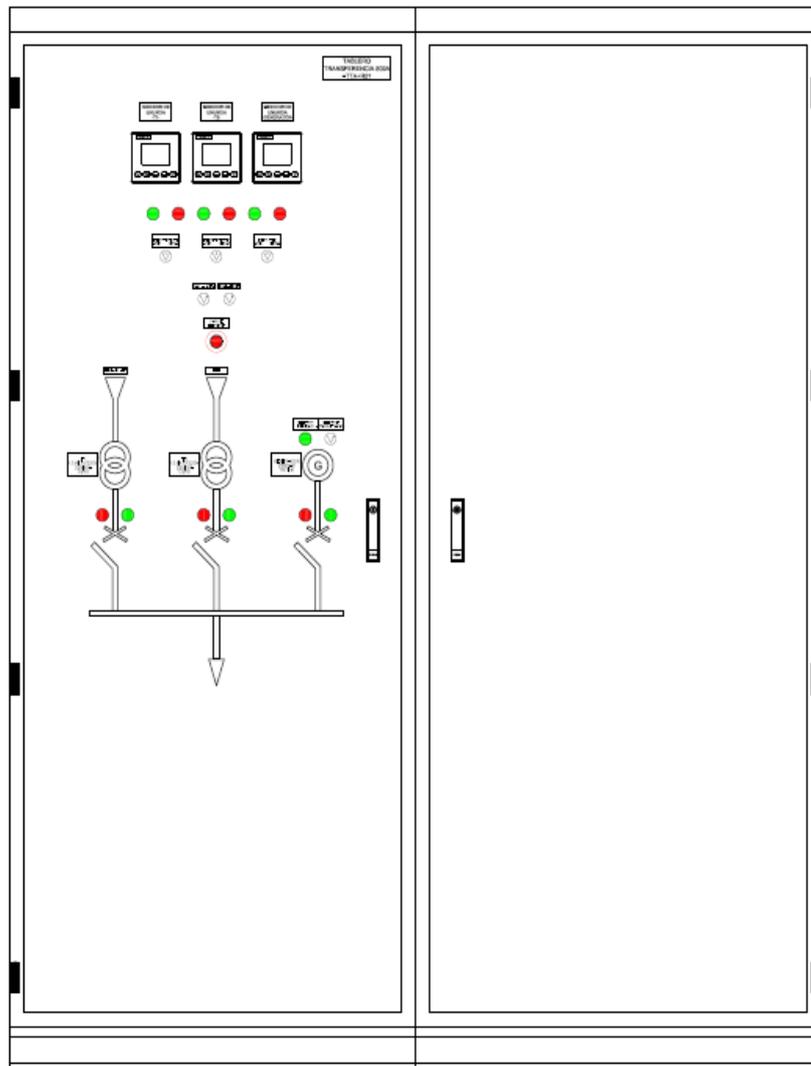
TABLERO DE ESTRUCTURAL.
